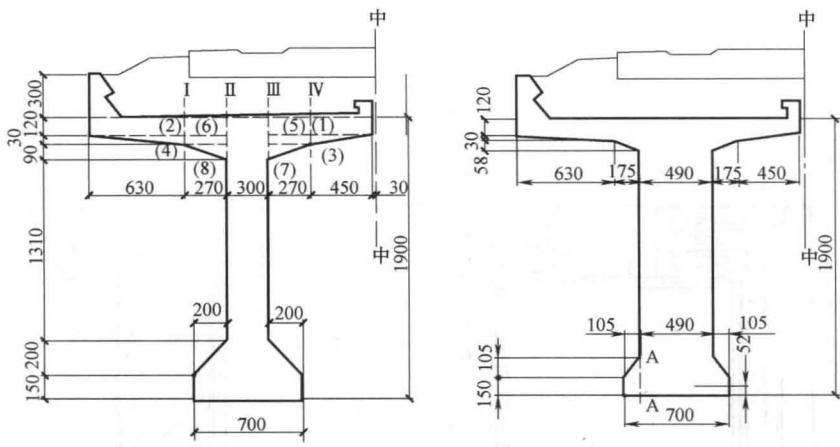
T 形梁跨中和梁端截面尺寸图 (单位: mm)
